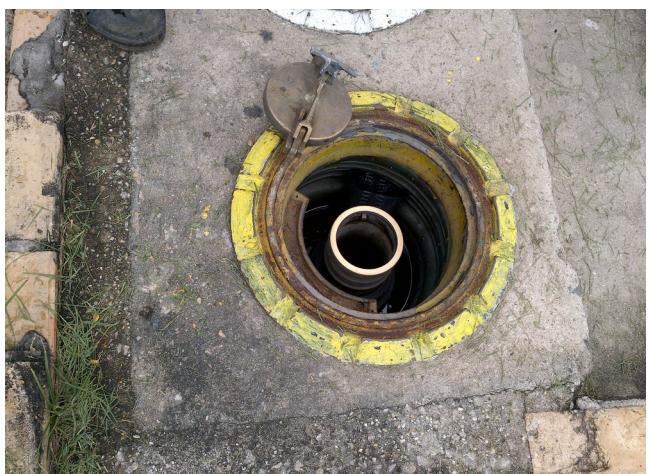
Sump da boca de descarga do tanque, sem dispositivo para descarga selada.
